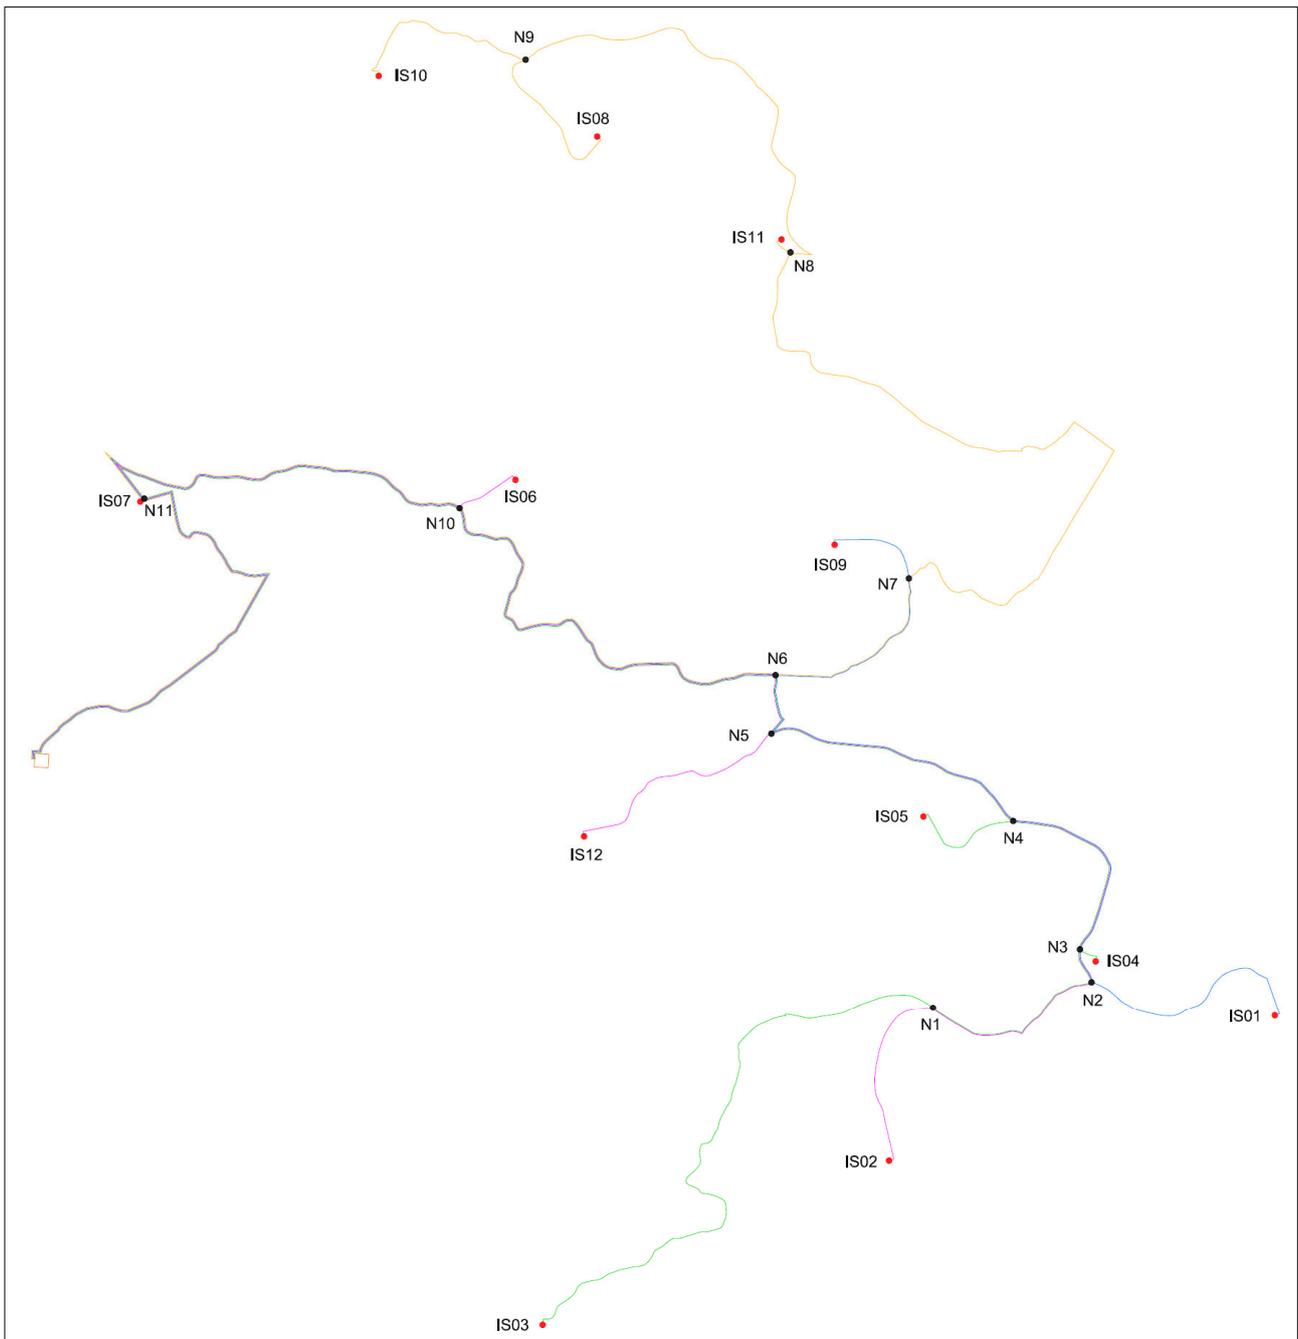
Planimetria generale di distribuzione delle linee a 33 kV
